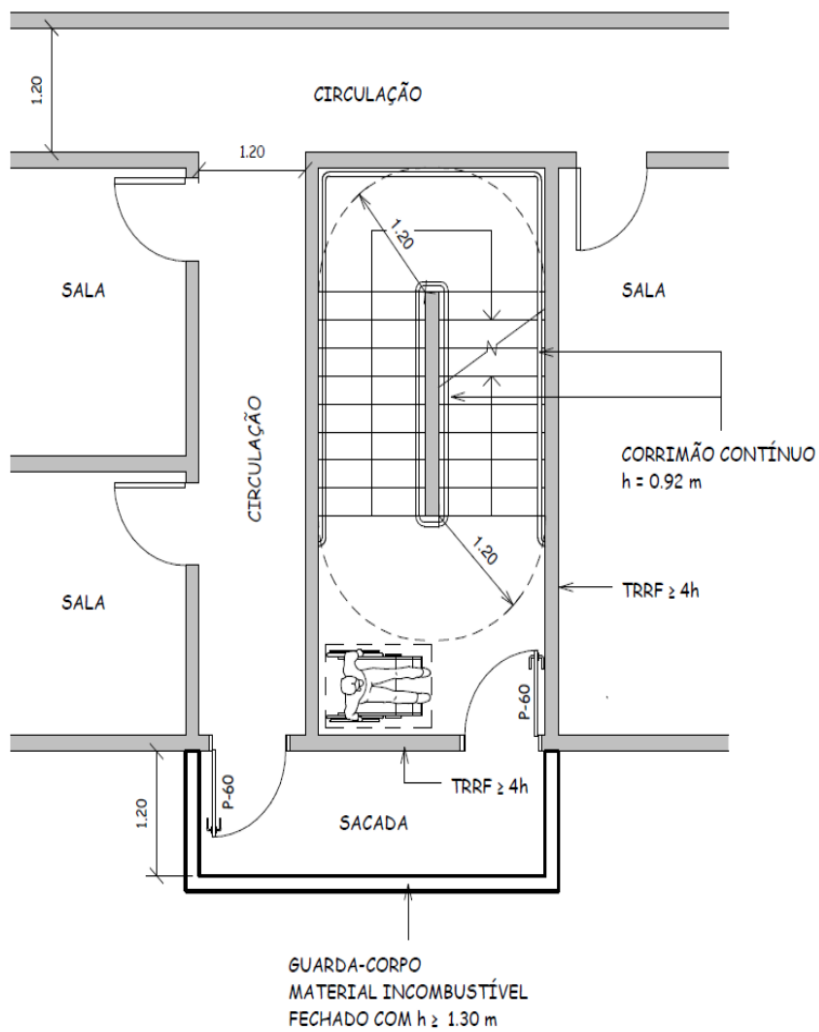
C - Escada à prova de fumaça aberta tipo sacada - pavimento intermediário (planta baixa).
